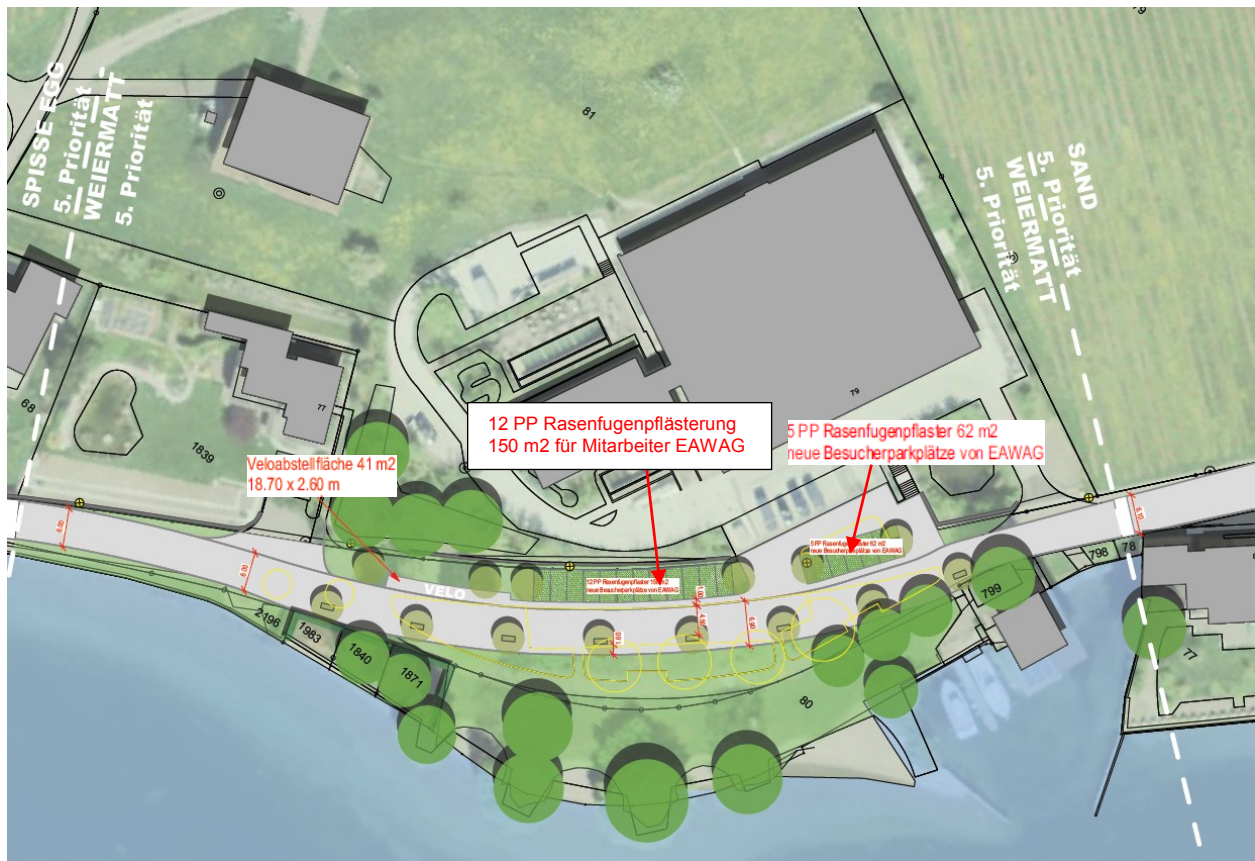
Planausschnitt Abschnitt Weiermatt
